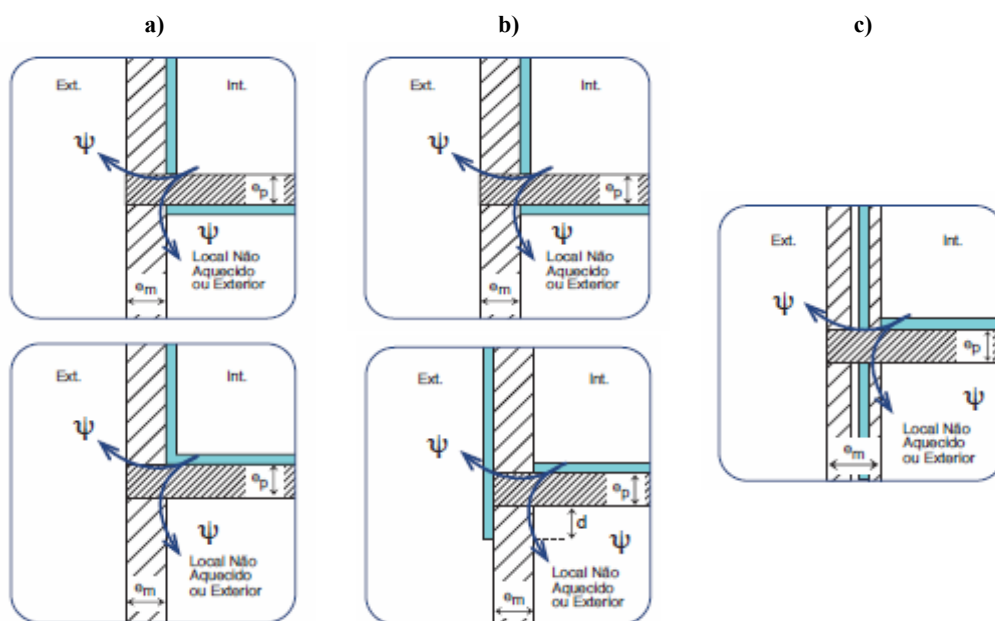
Ligação da fachada com pavimentos térreos
